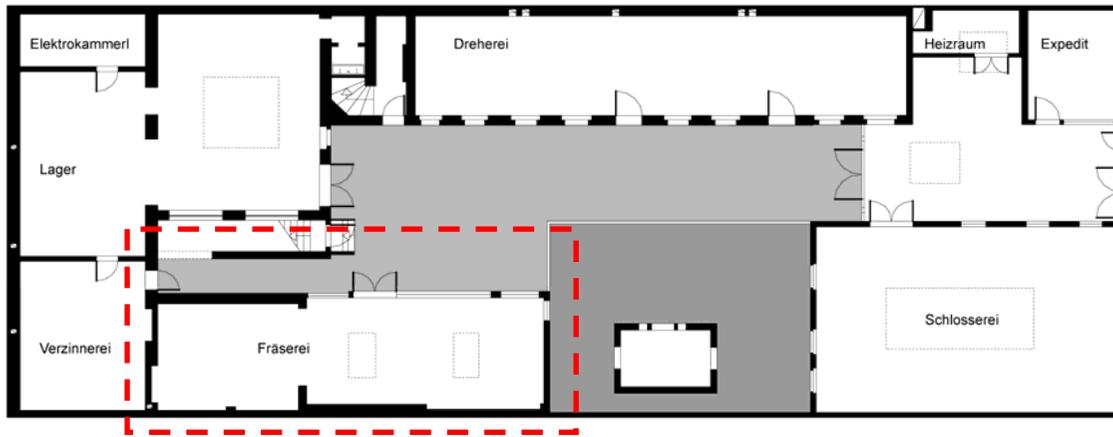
Grundriss Erdgeschoss mit der neuen Fräserei und dem neuen Aufgang ins erste Obergeschoss
